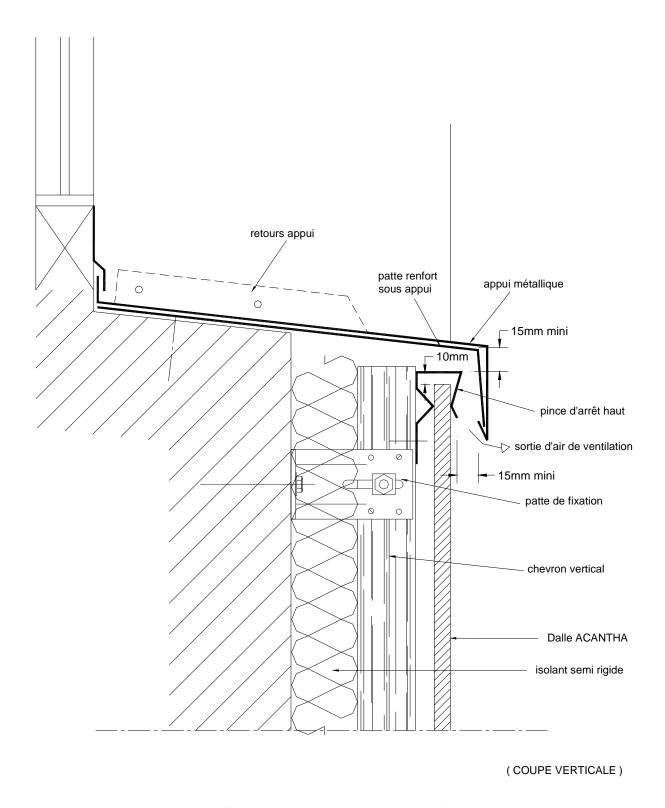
Habillage métallique en appui de baie avec fixation pincée des dalles en rive haute
